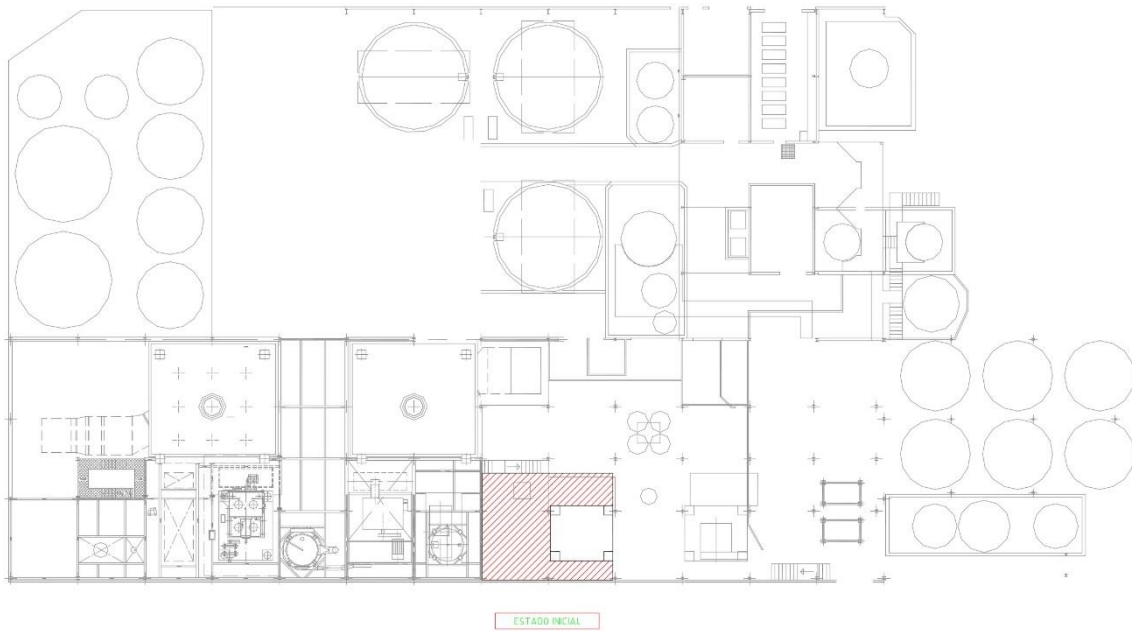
Plano AutoCAD de la planta de la nave industrial. En rojo se remarca la zona objeto de la aplicación práctica.
